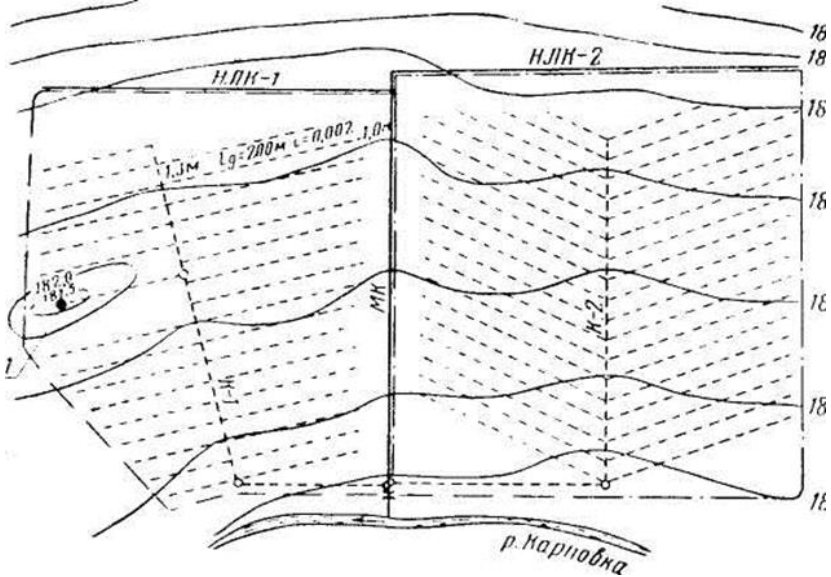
План участка, осушаемого закрытым дренажем (поперечная схема):
